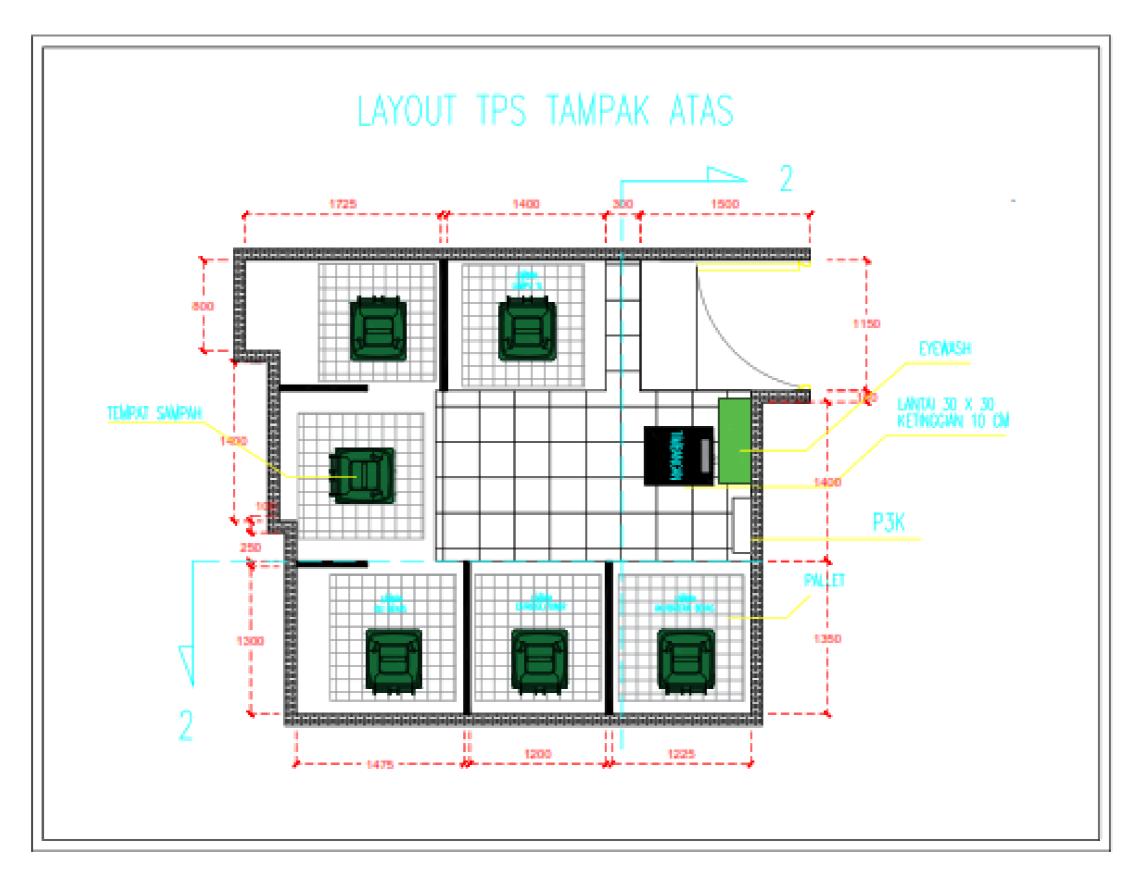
Layout TPS Limbah B3 Mangkuluhur City Tower One
